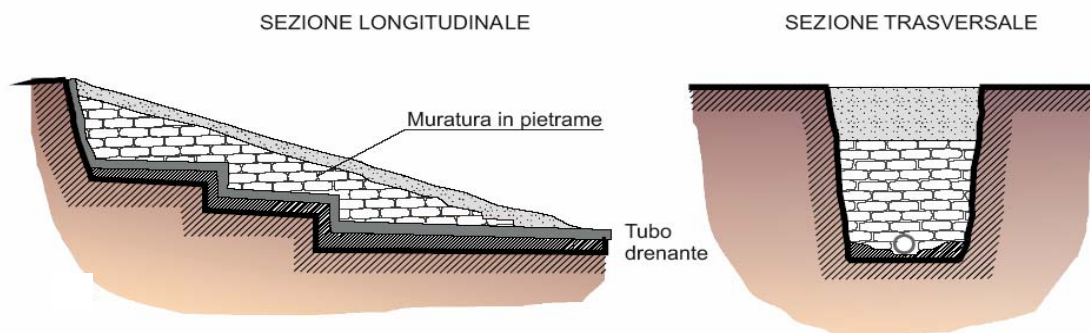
Rappresentazione schematica di uno sperone drenante in muratura a secco (da ANPA, 2002) -
